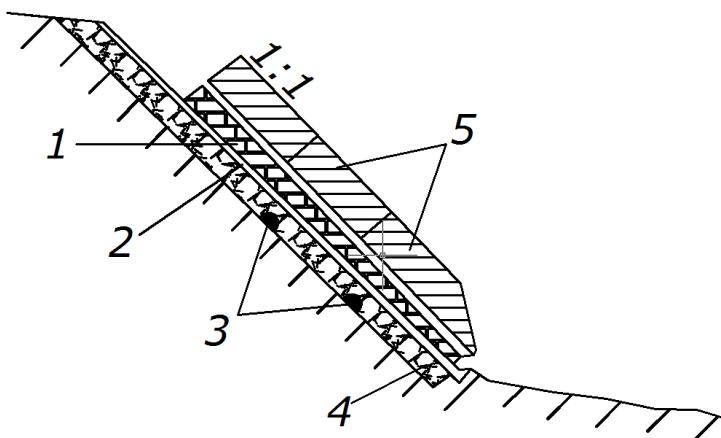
Скользящие массивы: 1-бруски-салазки; 2-направляющие железобетонные балки; 3-продольные железобетонные балки; 4-сухая кладка из крупных рваных камней; 5-скользящие массивы из бетонных блоков.
